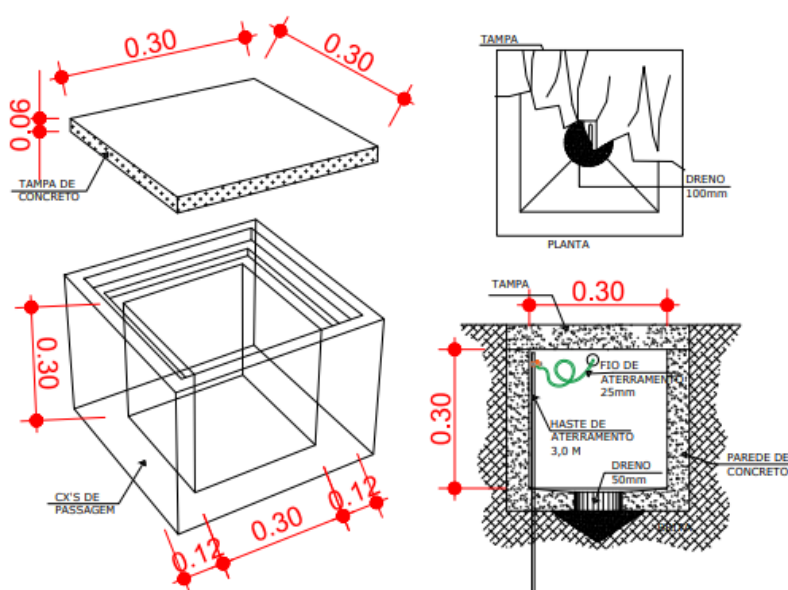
Detalhe de instalação da caixa de aterramento (Fonte: Autor/2024)
